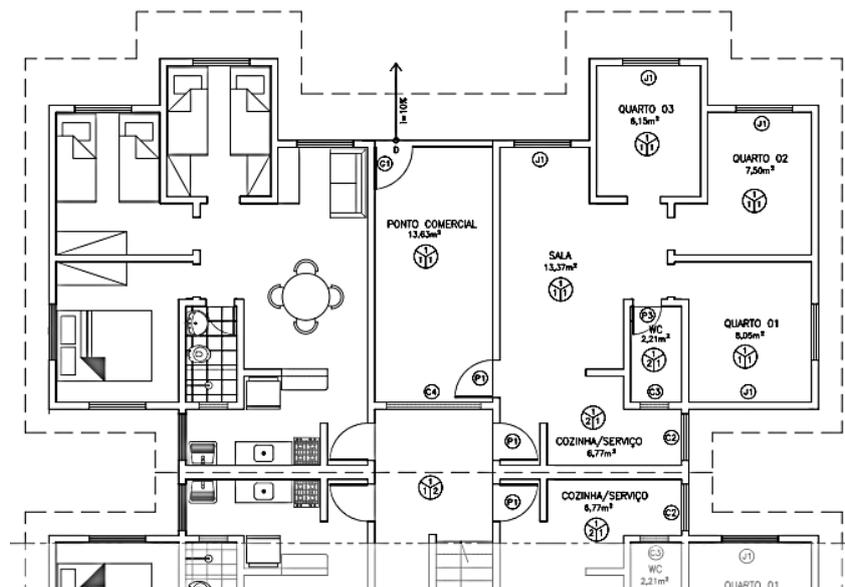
Planta Baixa do bloco tipo B. 3º pavimento. T3.
